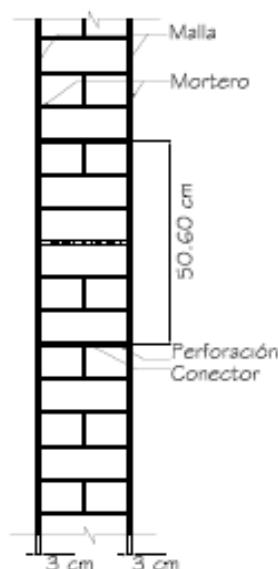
Recubrimiento de muros de mampostería con mortero reforzado.
